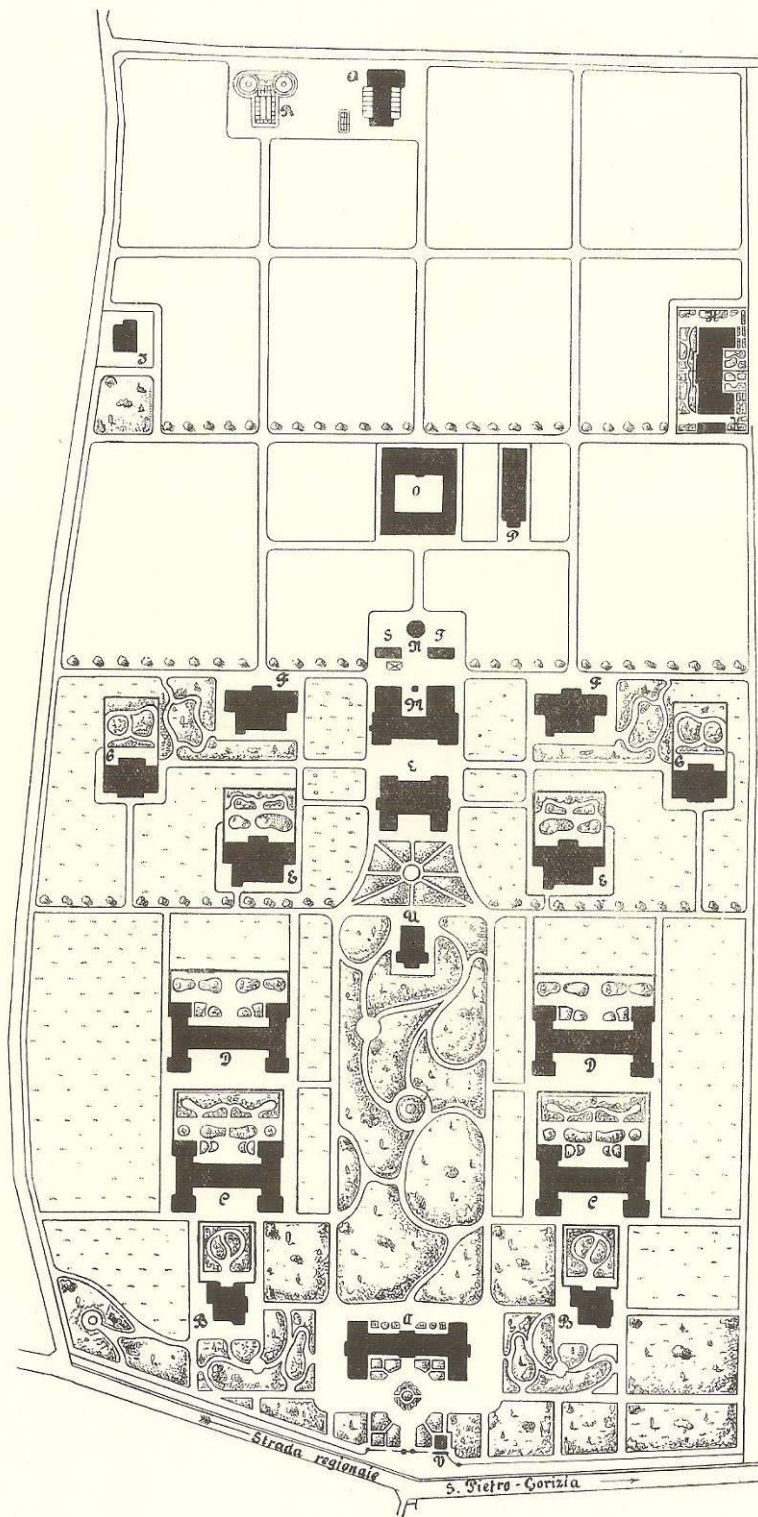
Lageplan der „Landes-Irrenanstalt Franz Josef I.“ in Görz
